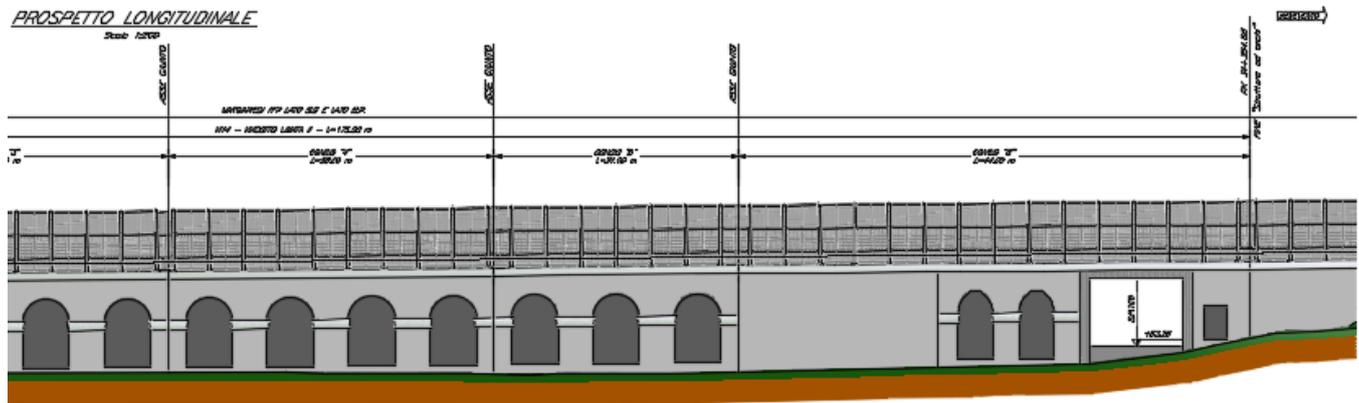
Prospetto del VI14 2 di 2 - “struttura ad archi”
